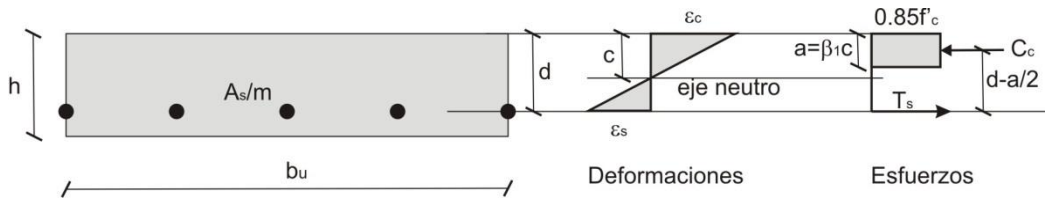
Sección de losa de ancho unitario, b_u con los diagramas de esfuerzo y deformación.
